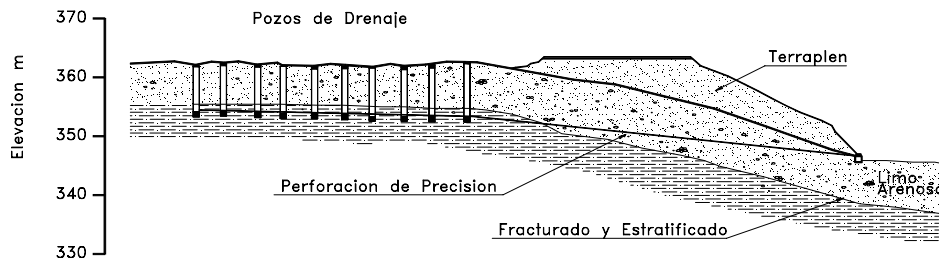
Pozos verticales conectados con ductos horizontales de PVC para drenaje (Colotta 1988).
